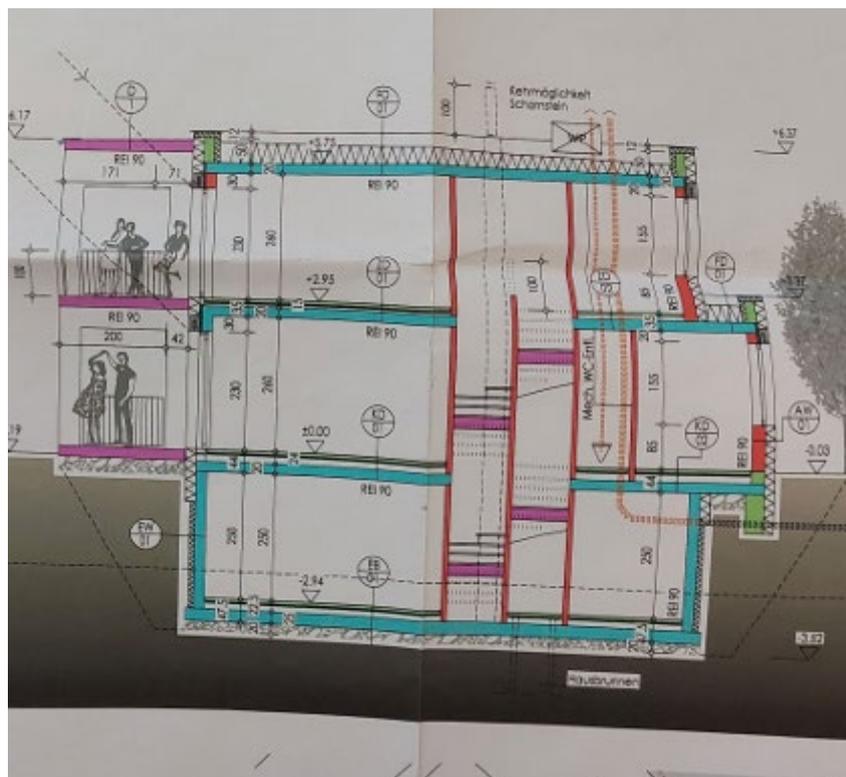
Schnitt | Einreichplan | 26.08.2014
